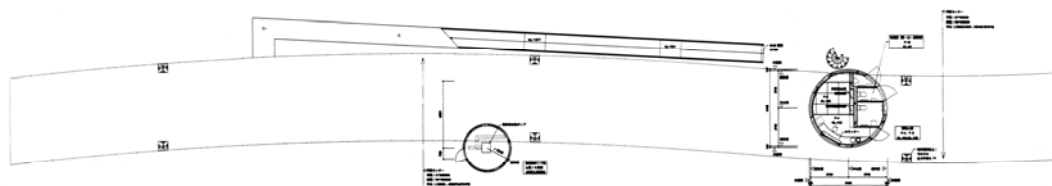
Museu-O. Planta do pavimento térreo.
